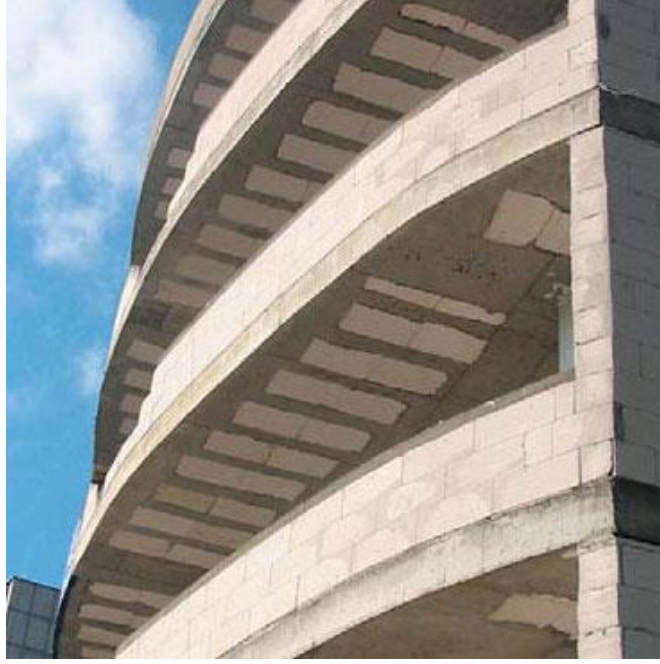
Gazbeton Dolgu Blokların Üzeri 5-7cm Üst Başlık Betonu Kaplanması
